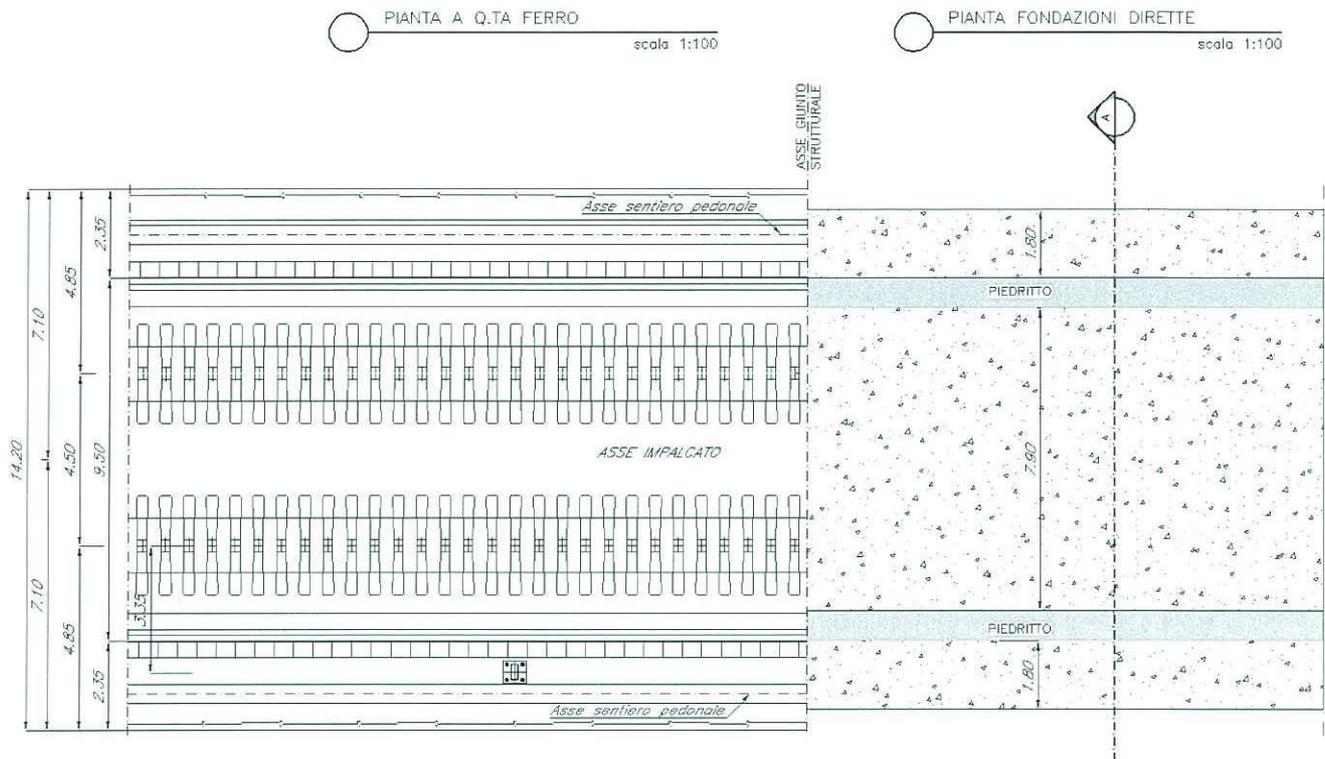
Pianta a quota ferro e pianta fondazioni dello scatolare.
